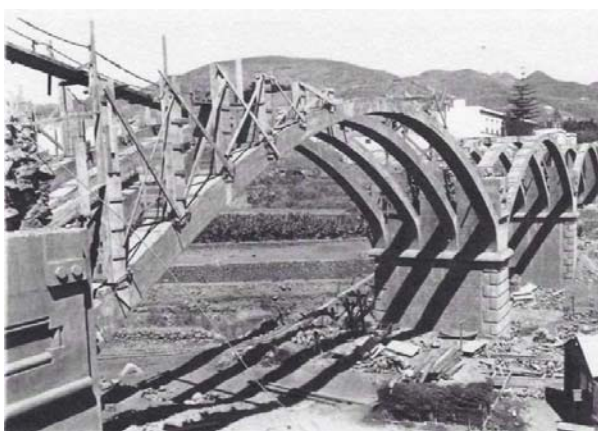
Foto histórica de los arcos exentos del puente Galcerán, hormigonados en fase de construcción
